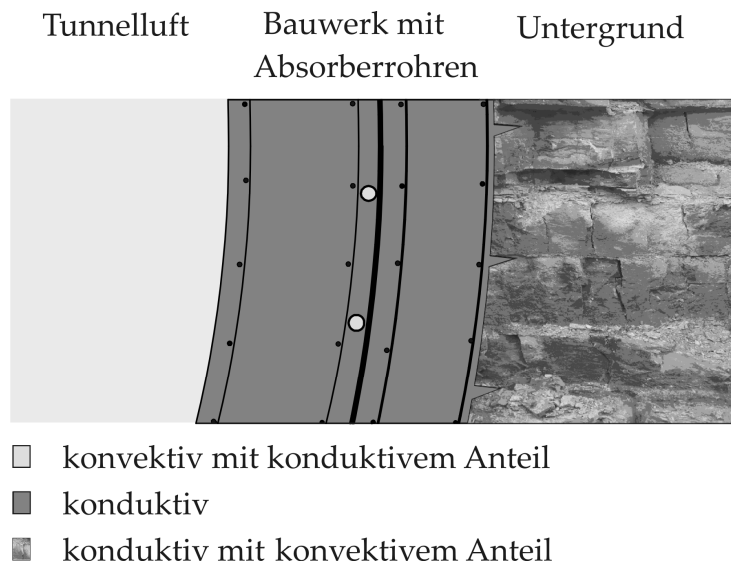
Wärmetransportmechanismen im System Tunnelluft – Bauwerk – Untergrund.
